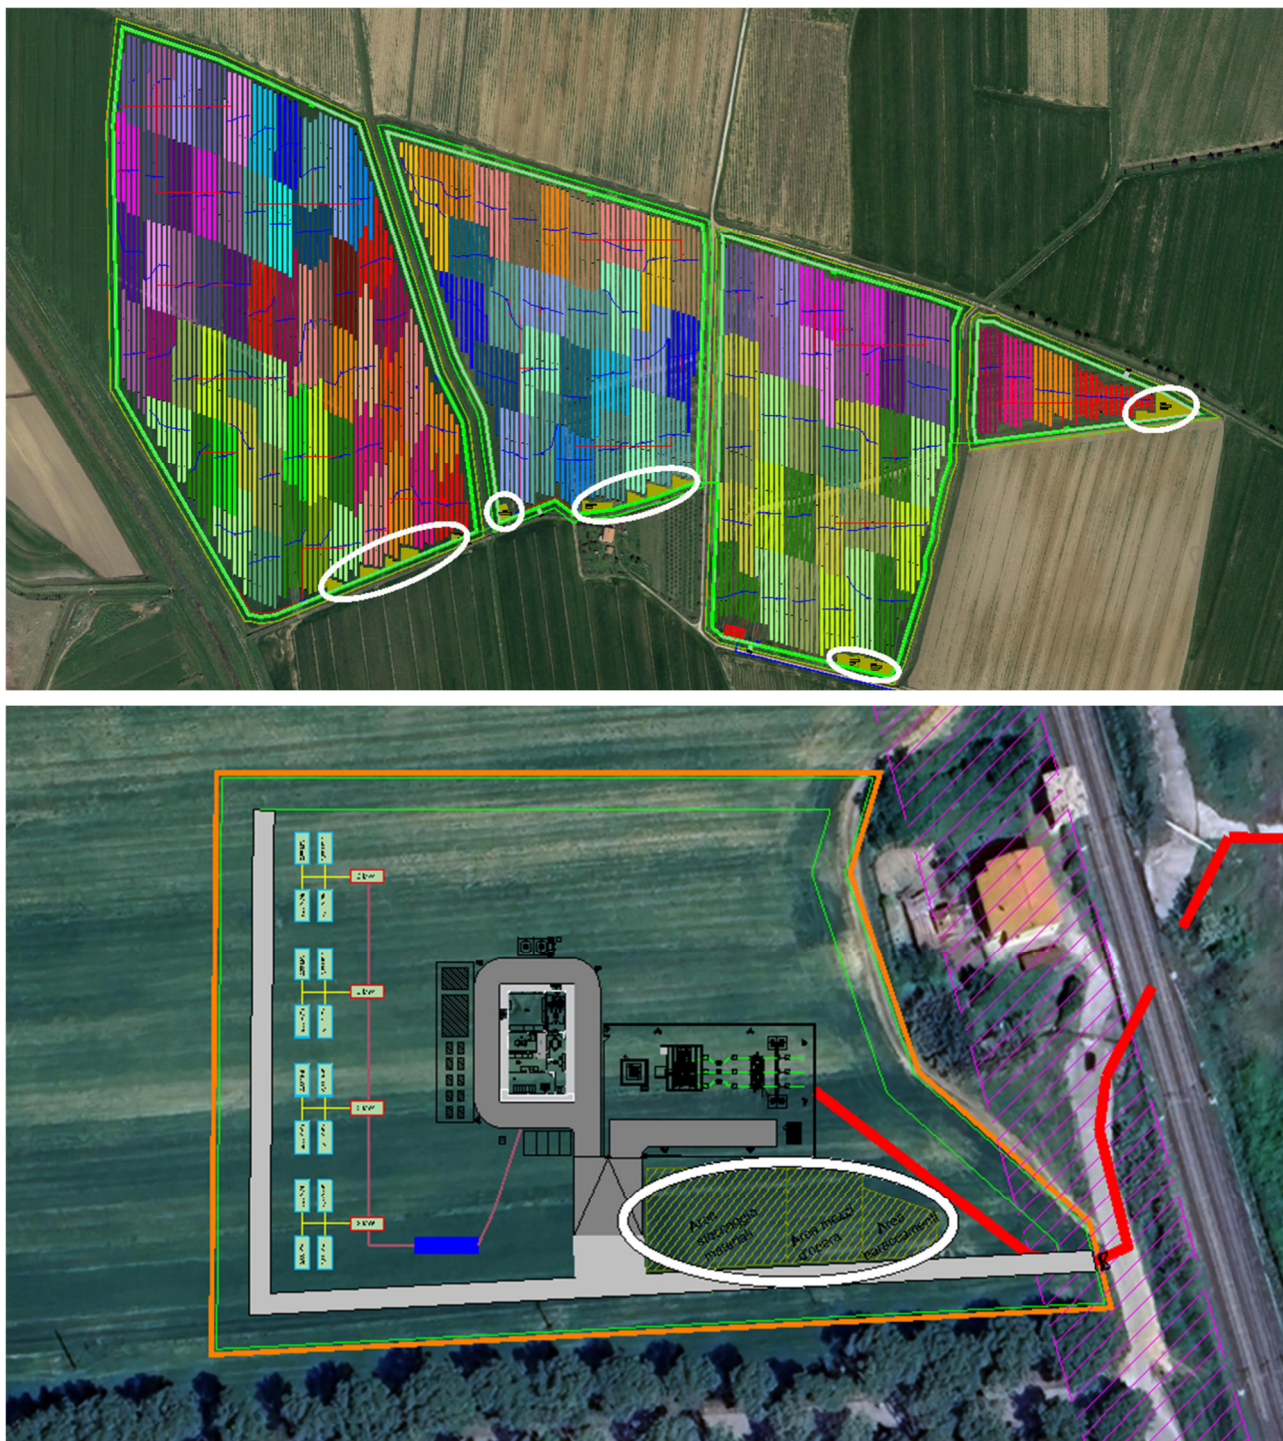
Planimetria con ubicazione delle aree tecniche di cantiere
